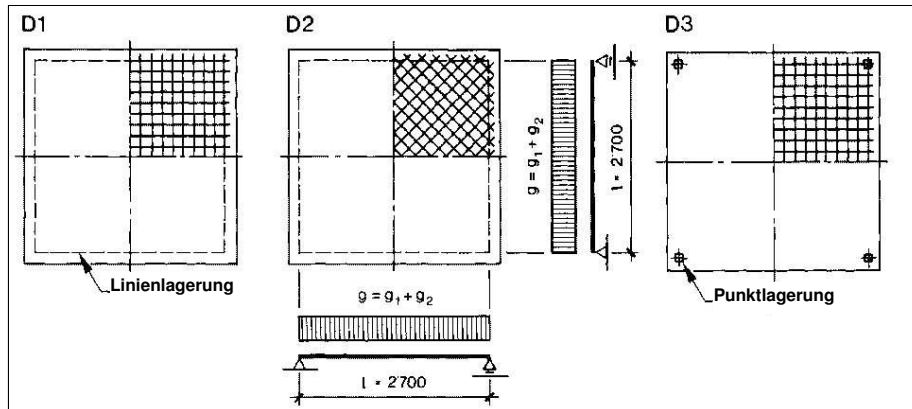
Statisches System, Geometrie und Lage der unteren Bewehrung der Versuchsreihe D (Maße in [mm]); Quelle: Tellenbach (1985)
